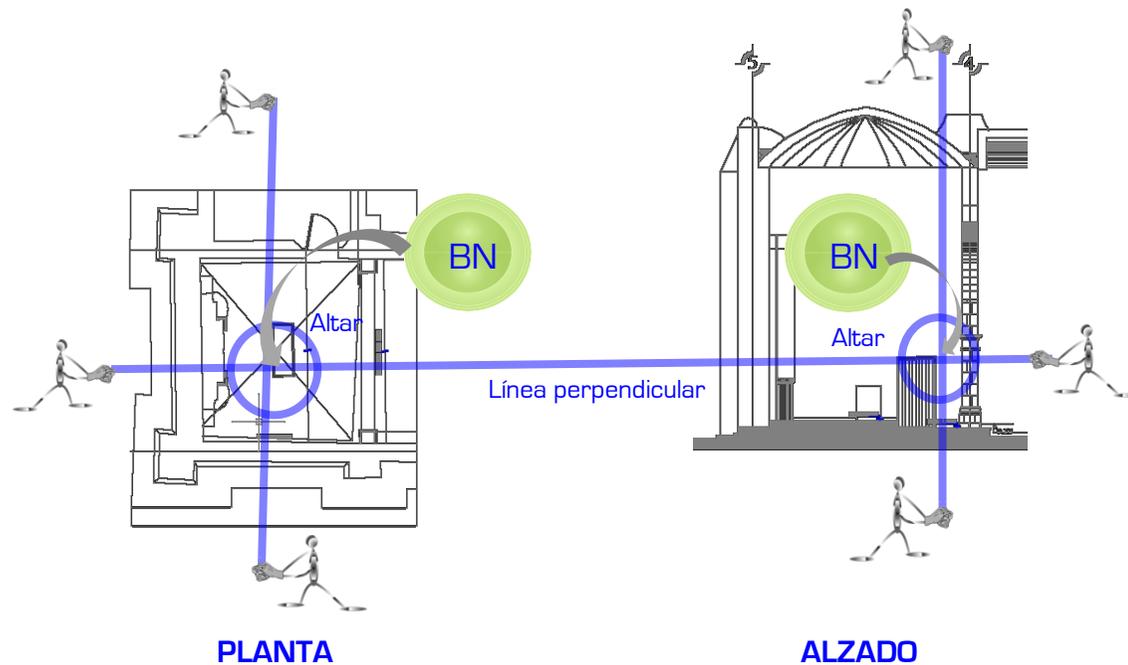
Ubicación de banco de nivel (Planta y corte)
